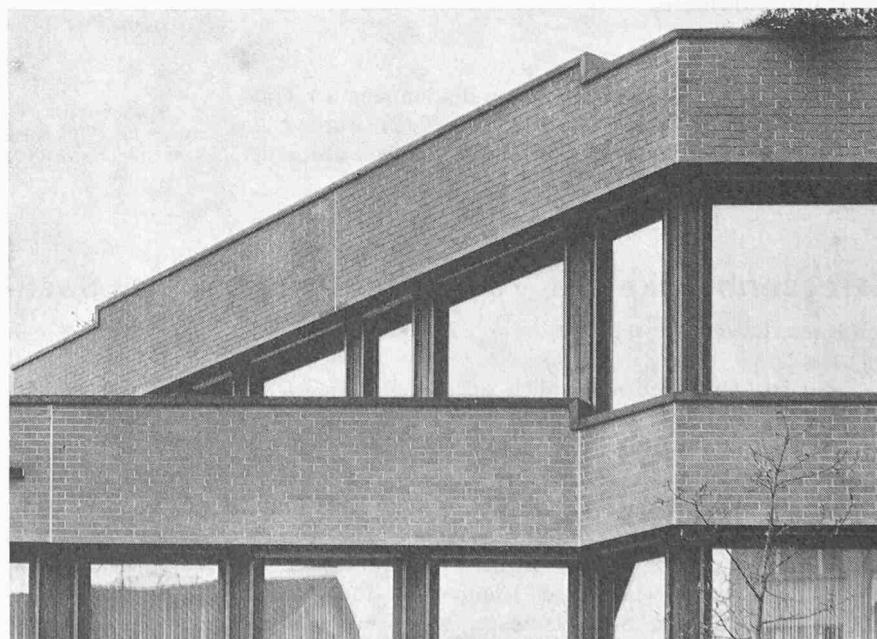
Weitgespannte selbsttragende Preton-Fassadenelemente in Sichtmauerwerk
